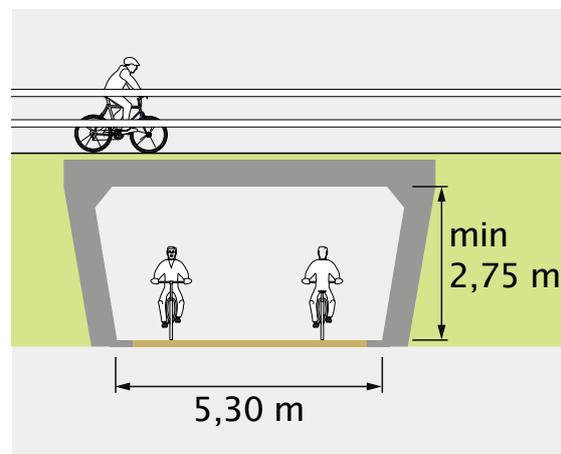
Hauteur minimale pour les passerelles cyclables.
